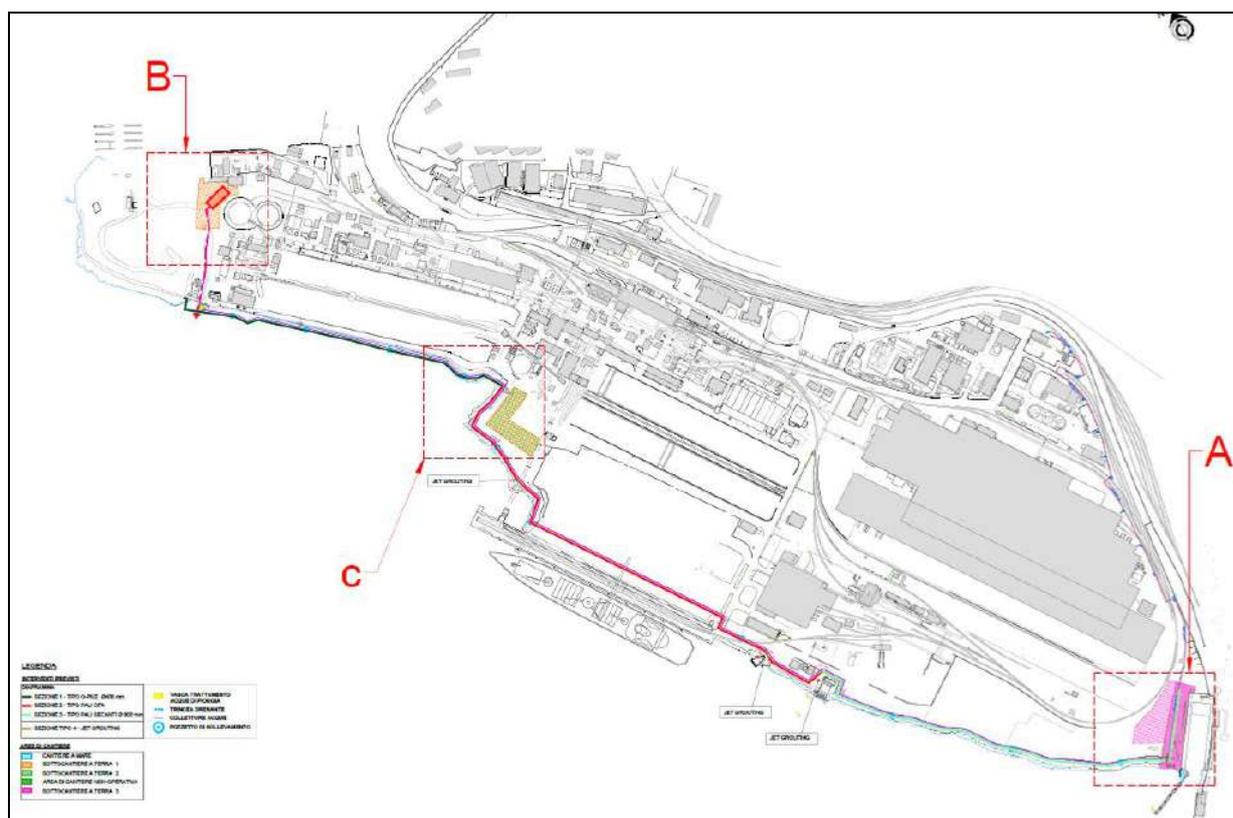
cantiere principale (A) e cantieri satelliti (B e C)
